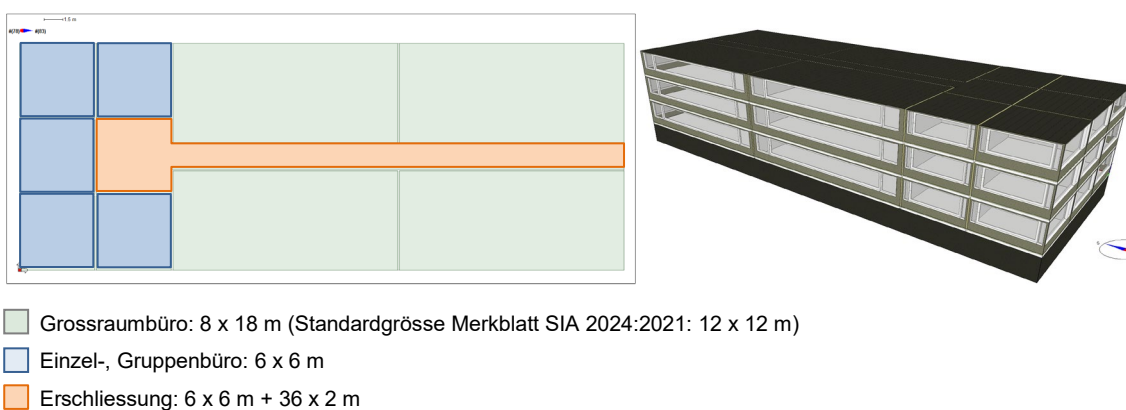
Grundriss mit Zoneneinteilung (links) und 3-D-Darstellung (rechts) des Bürogebäudes.
